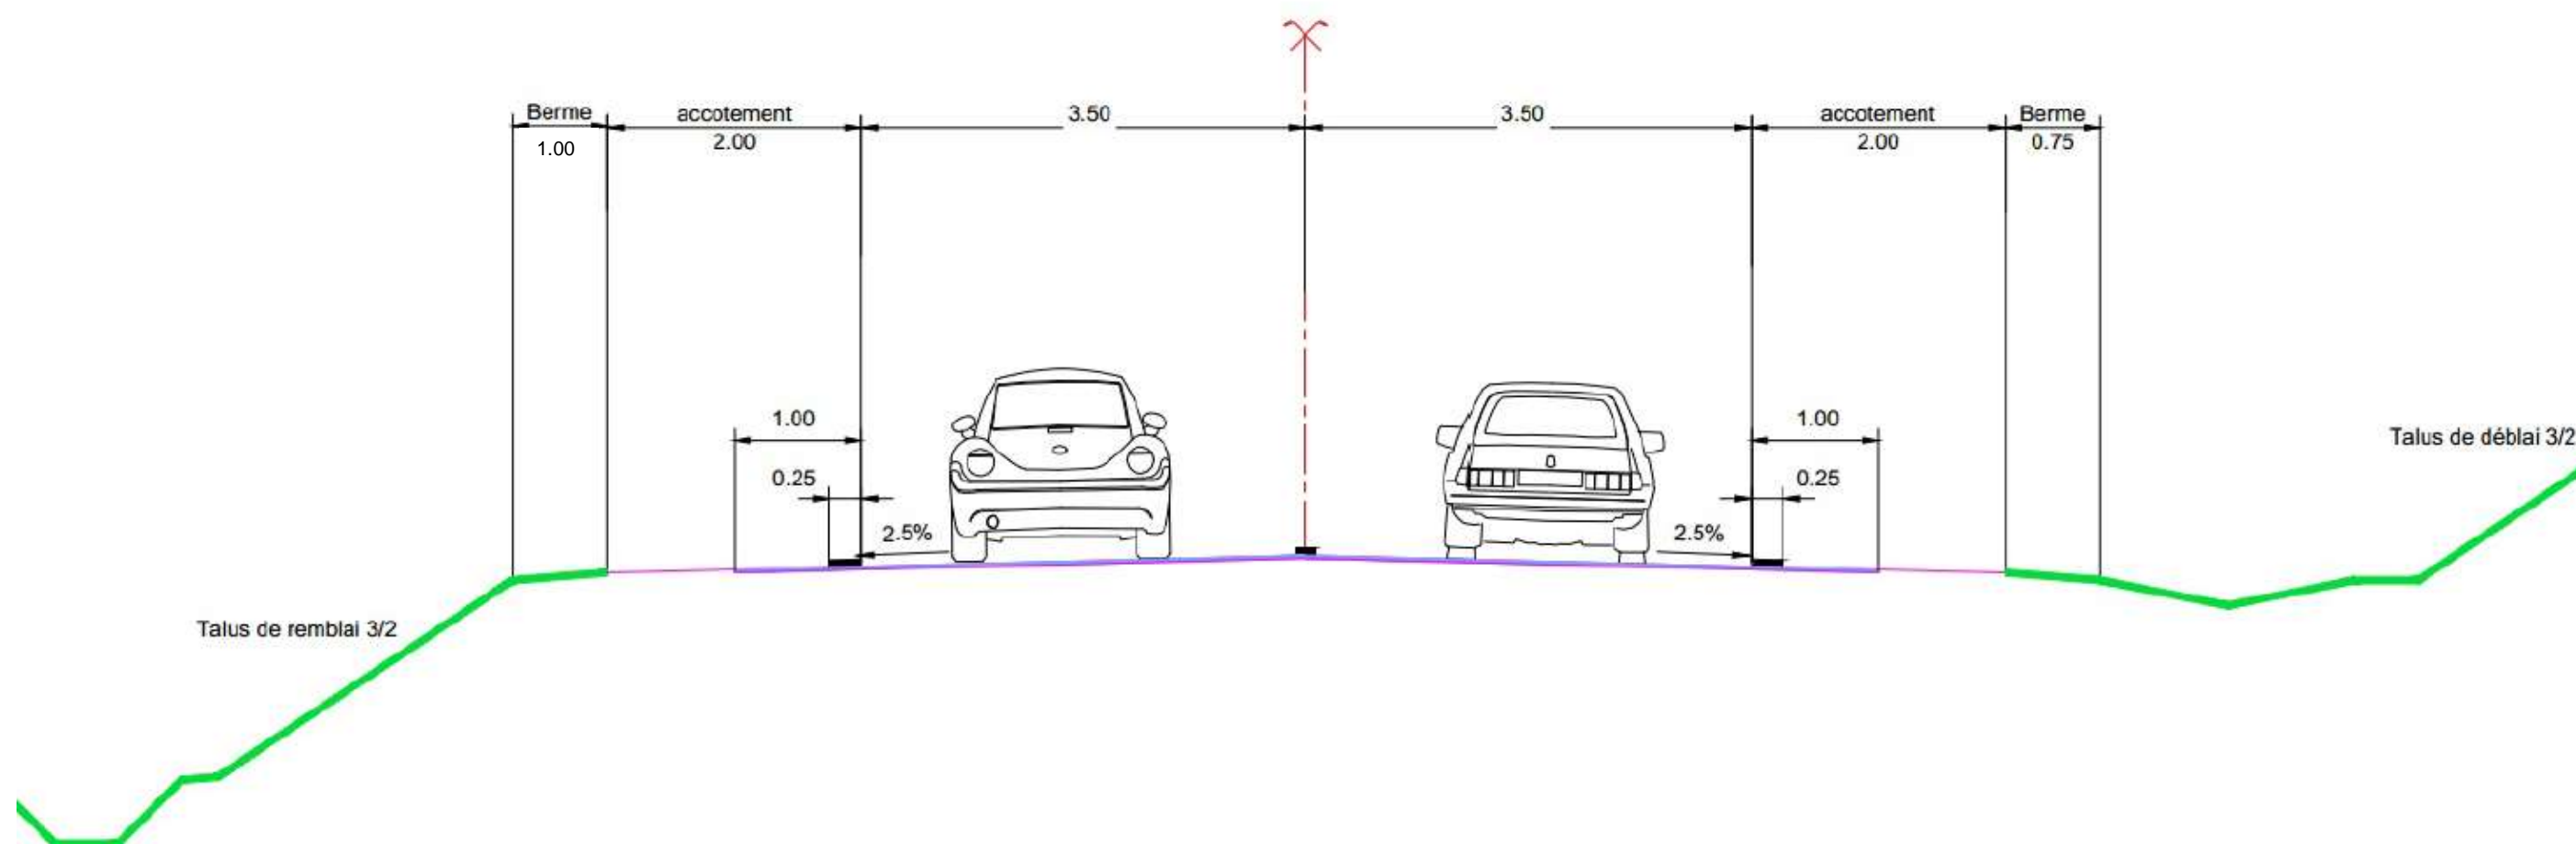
Profil en travers type en section courante (en 2x1 voie)
